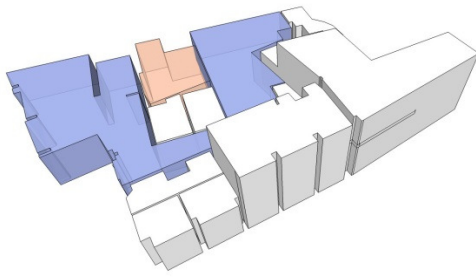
68_ Comedor-caja de escaleras (Planta baja).
